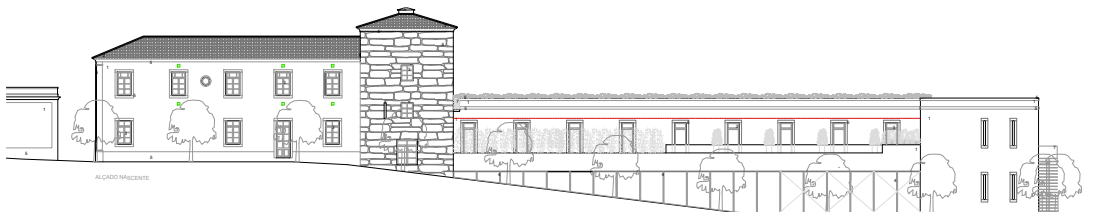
Alzado nascente (2022). Fuente: Queiras & Xedas Construções.
